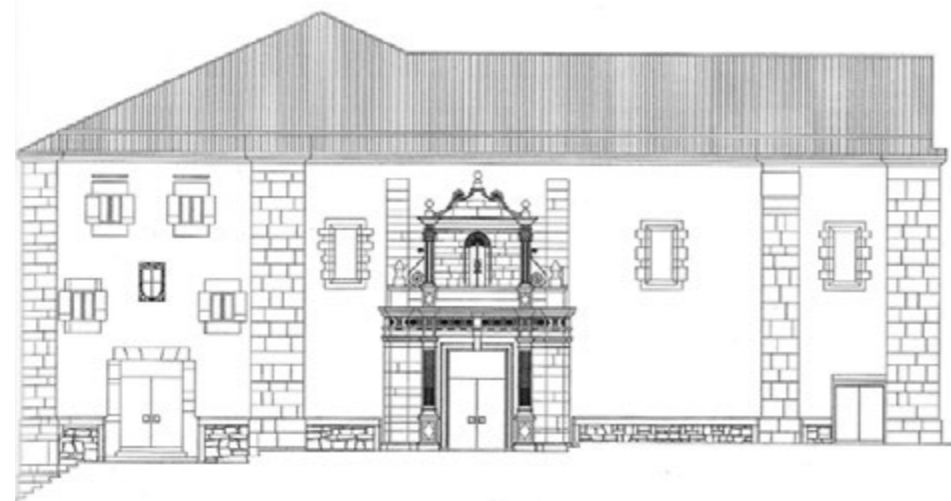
Fachada principal del convento. Plano de Cosme Cuenca y Jorge Hevia (Madrid 2009:51).
